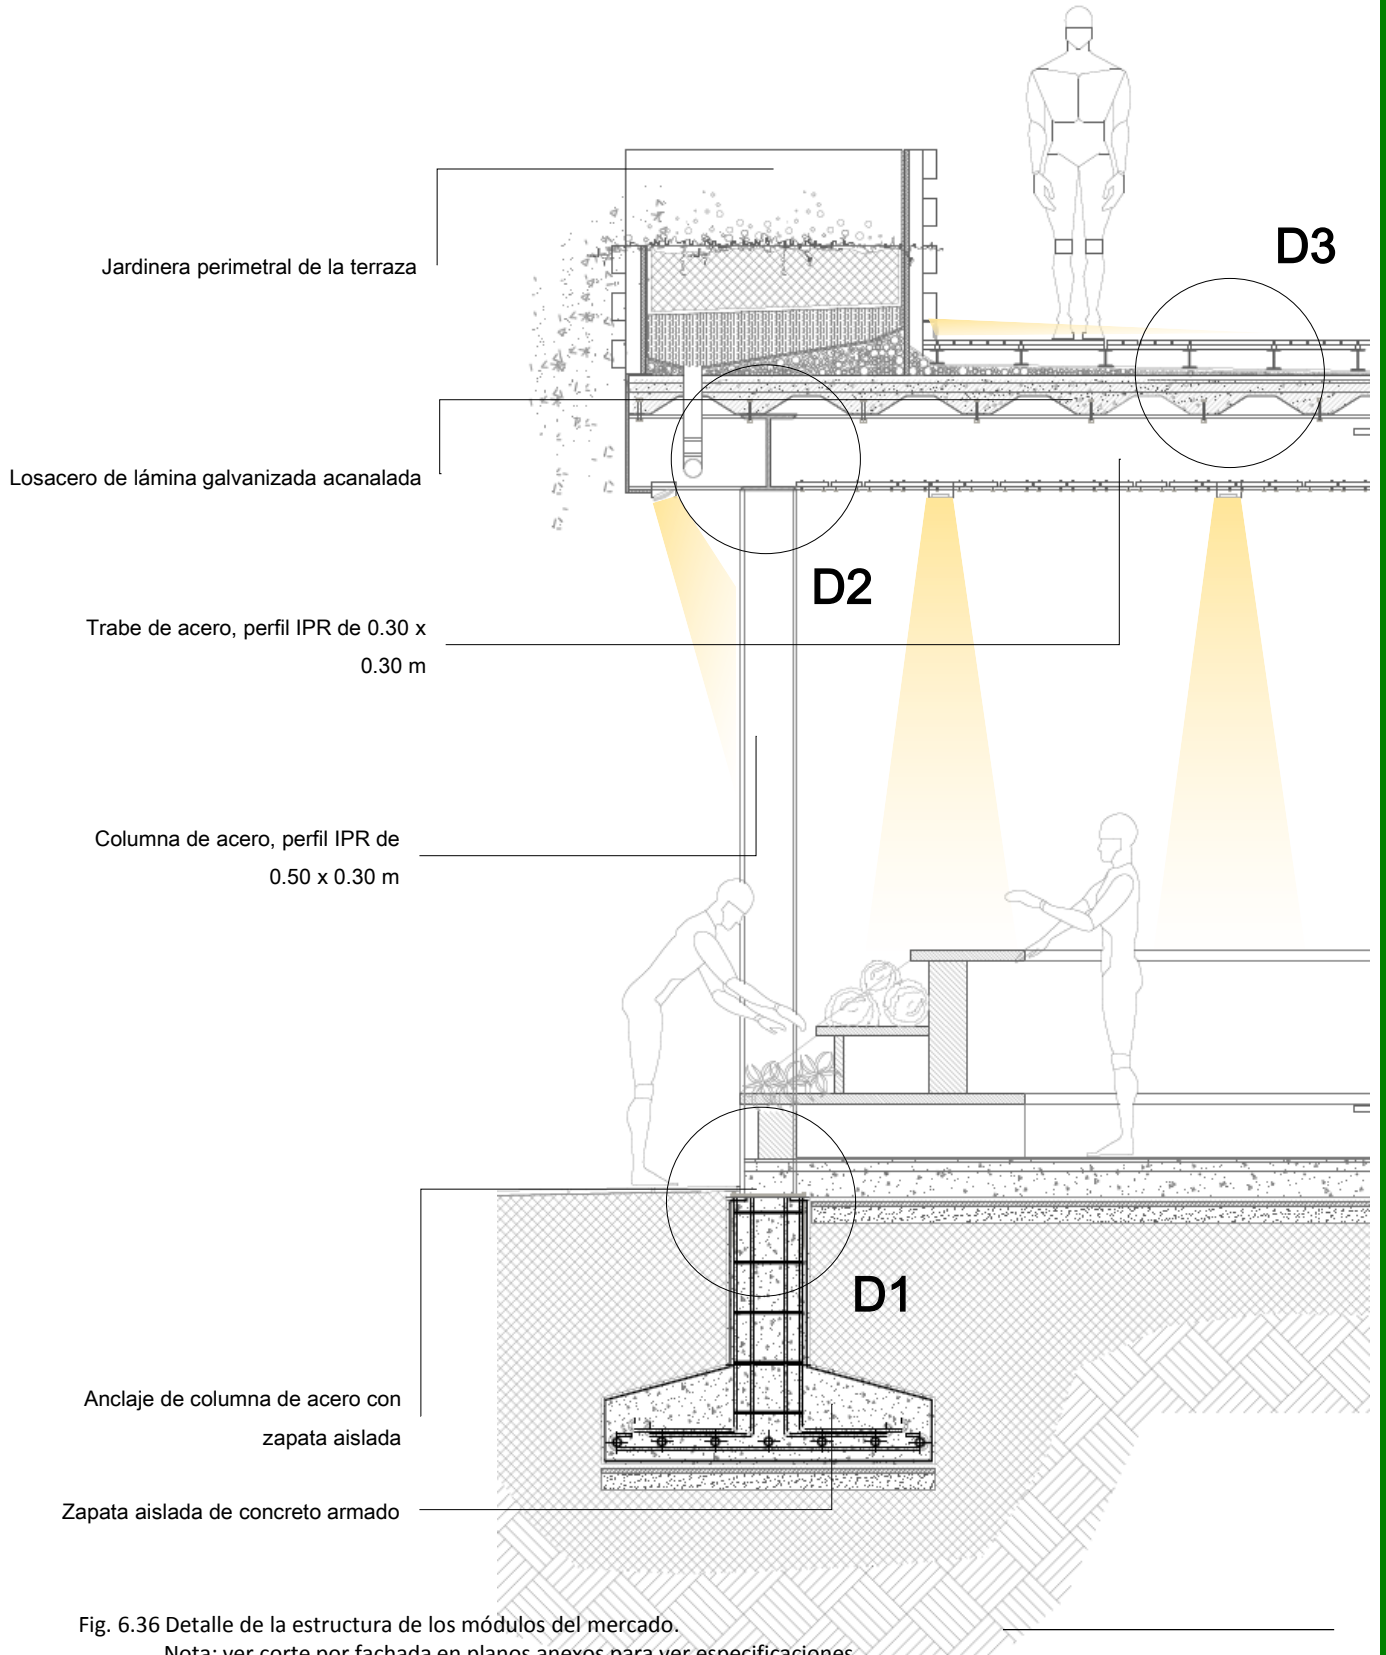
Detalle de la estructura de los módulos del mercado.
